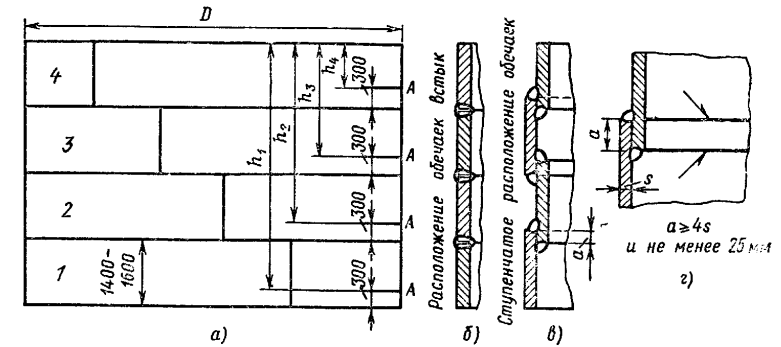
Сварные соединения обечеек резервуаров
